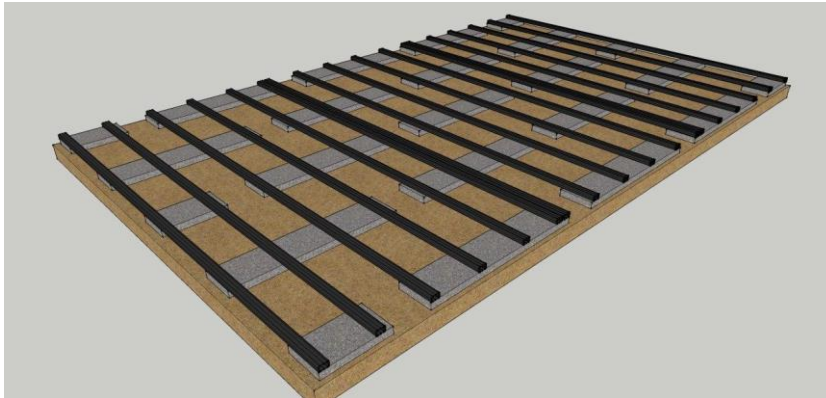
Die Unterkonstruktion muss an jedem Auflagepunkt befestigt werden.
